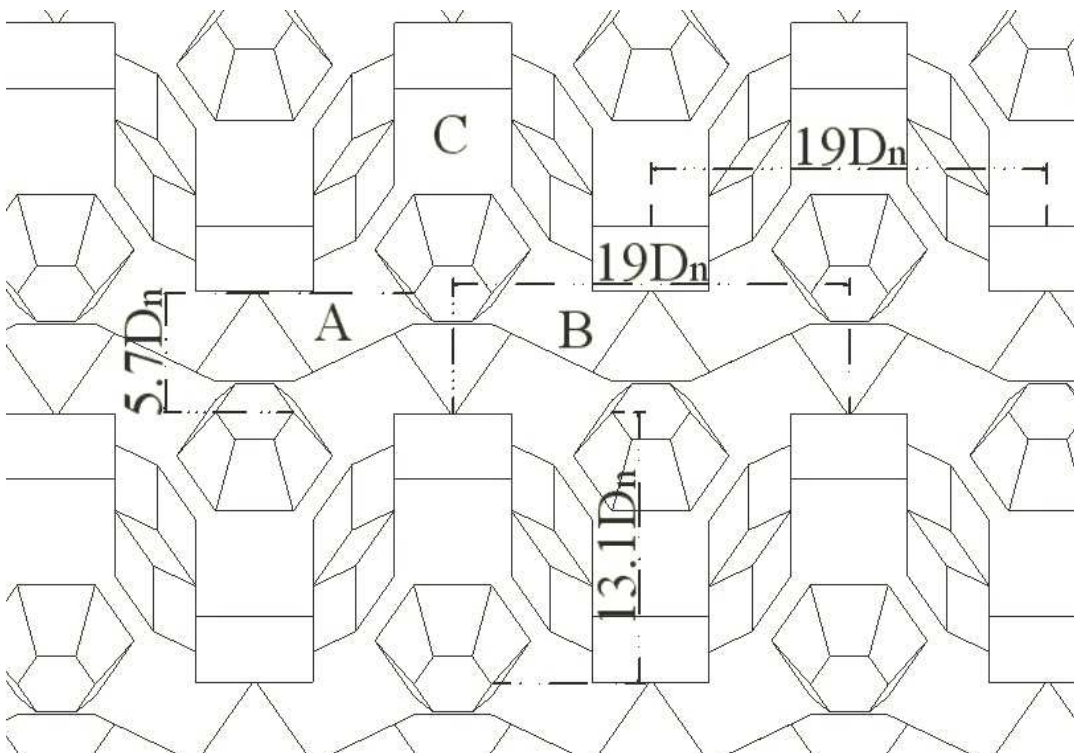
Vue du plan de pose 3 ('alternatif')
